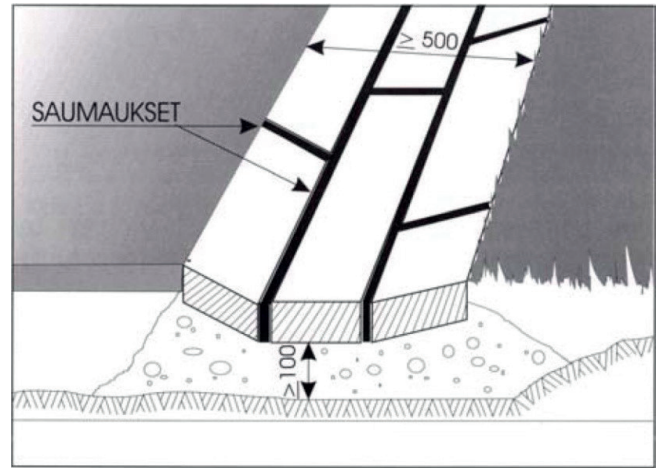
Betonielementtikourun alle asennettu puusoirot.
